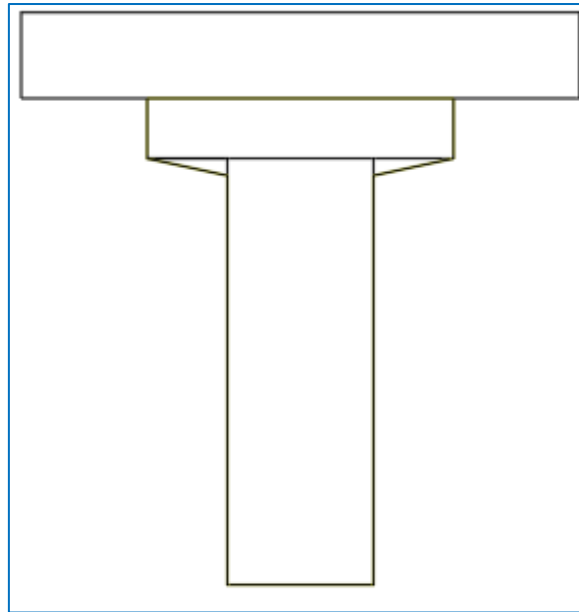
La section de la poutre à « l'about + l'hourdi »
